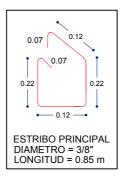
ESTRIBO DE VIGA DE CIMENTACIÓN
